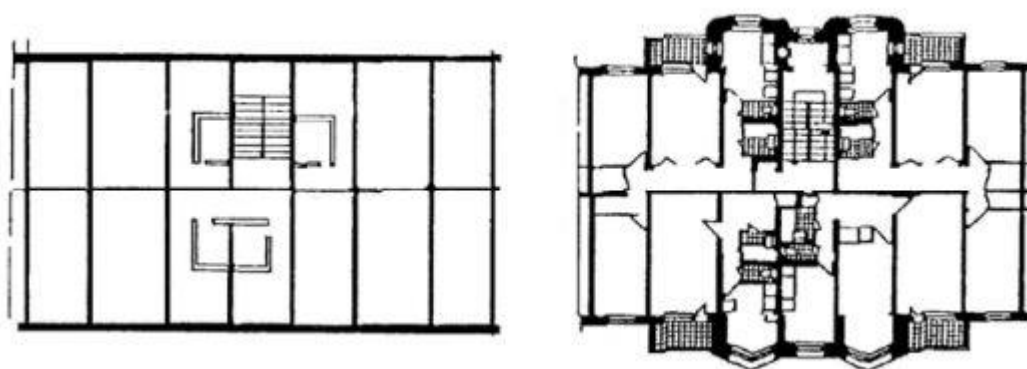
Пример реконструкции секции жилого дома при перекрёстной схеме с малым шагом поперечных несущих стен: конструктивная схема до реконструкции (слева); перепланировка секции при реконструкции (справа)
